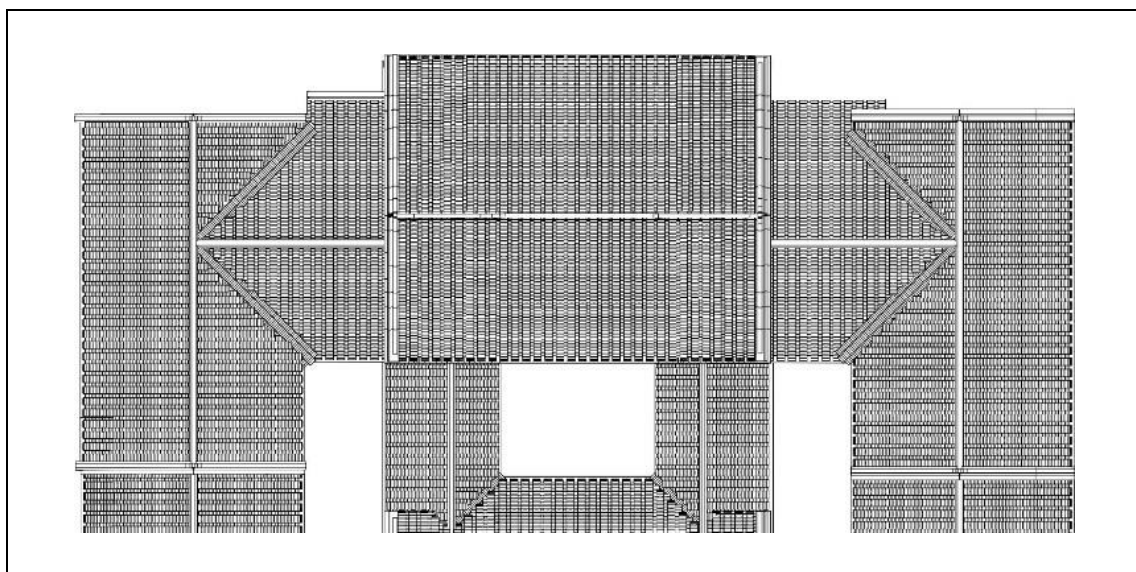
內埔鄉謝氏宗祠歷史後堂屋面平面圖
